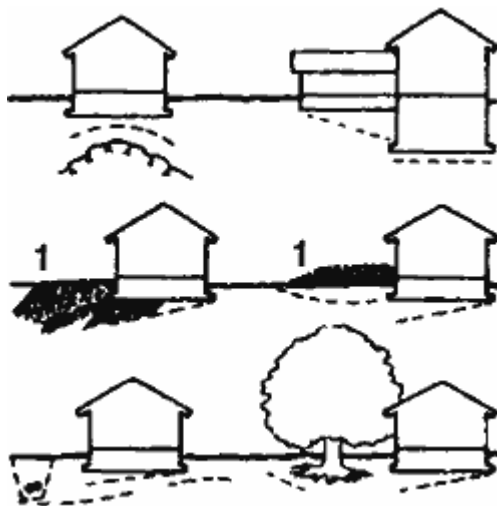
Провал фундамента вызывается различным составом грунта в основании здания, различиями в нагрузках, недостаточно тщательно уплотненной засыпкой, изменением уровня грунтовых вод: 1 – насыпной грунт.
